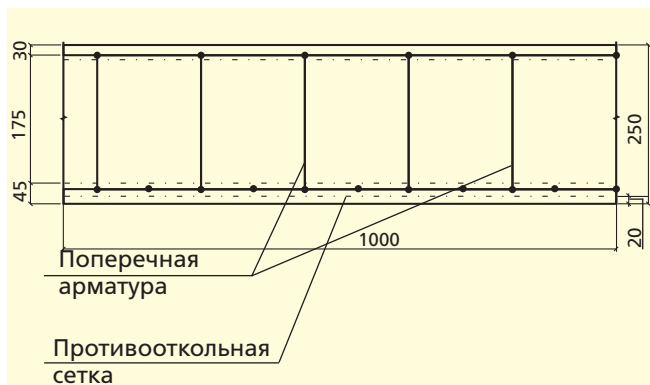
Пример армирования монолитной железобетонной плиты перекрытия
